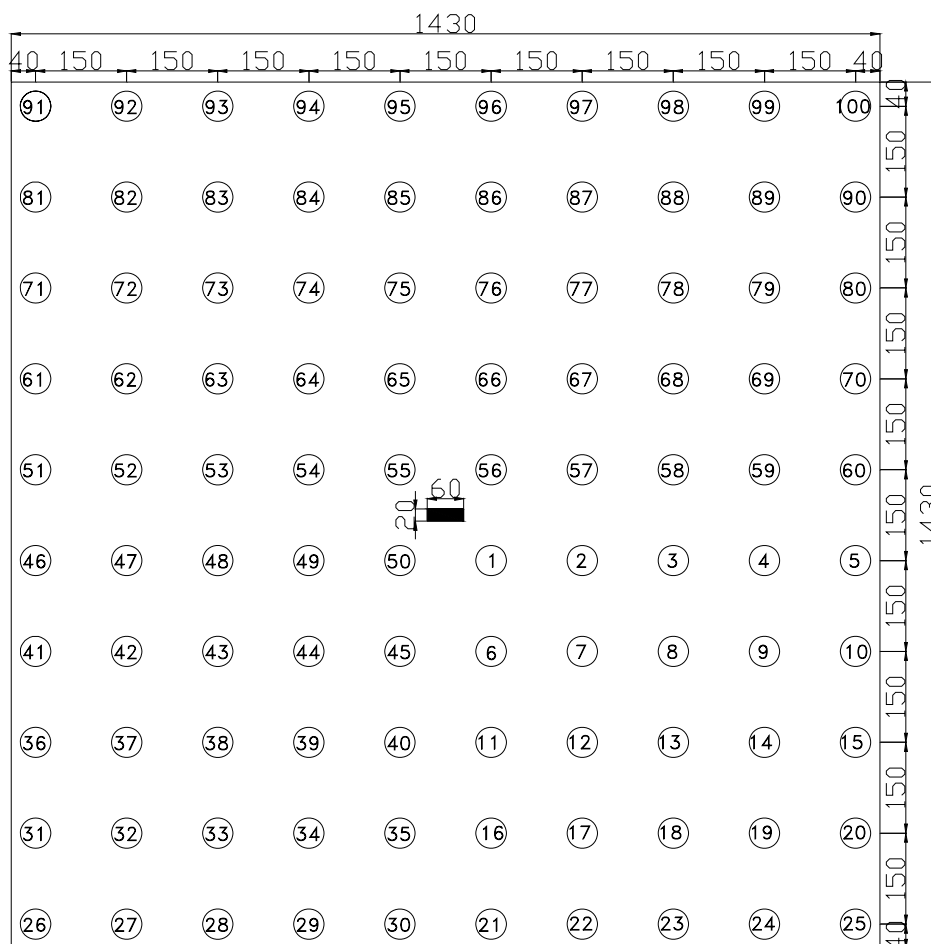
Radier sobre 100 estacas com o pilar no central
